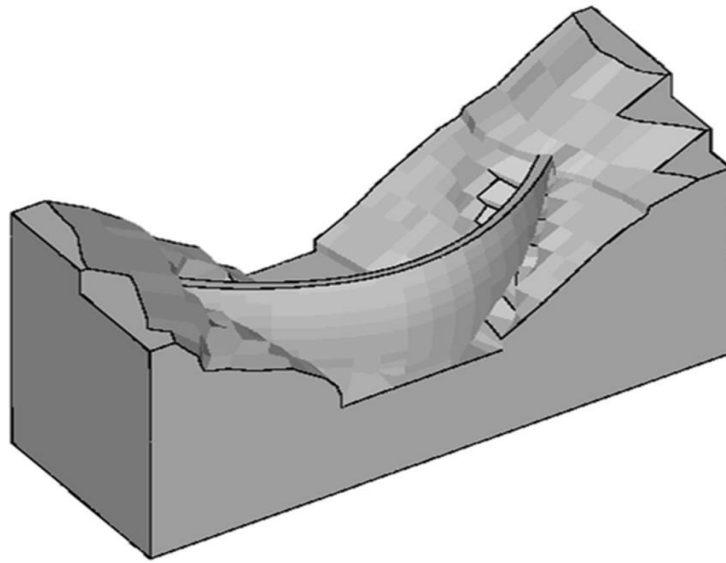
Ejemplo de estructura masiva: presa bóveda con su cimentación.
